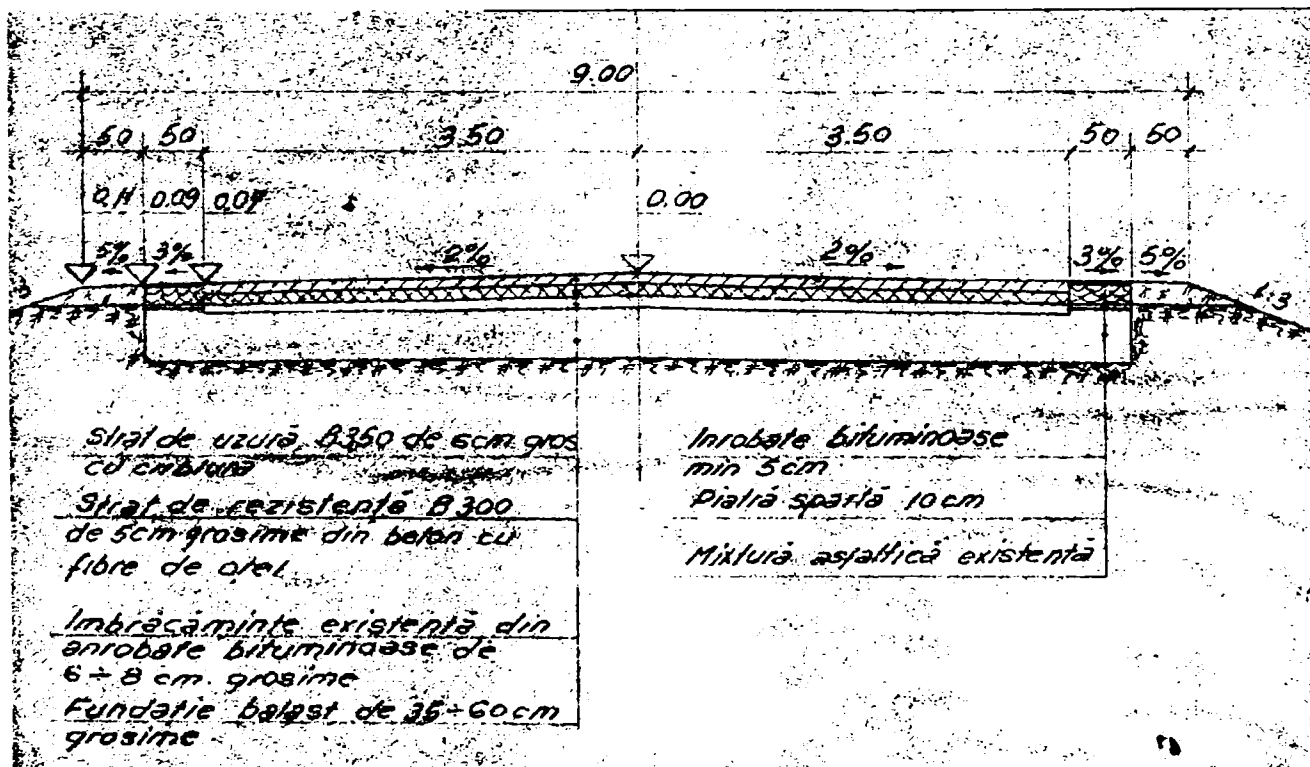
Profil transversal Tip III cu îmbrăcăminte din beton armat cu fibre din oțel.
